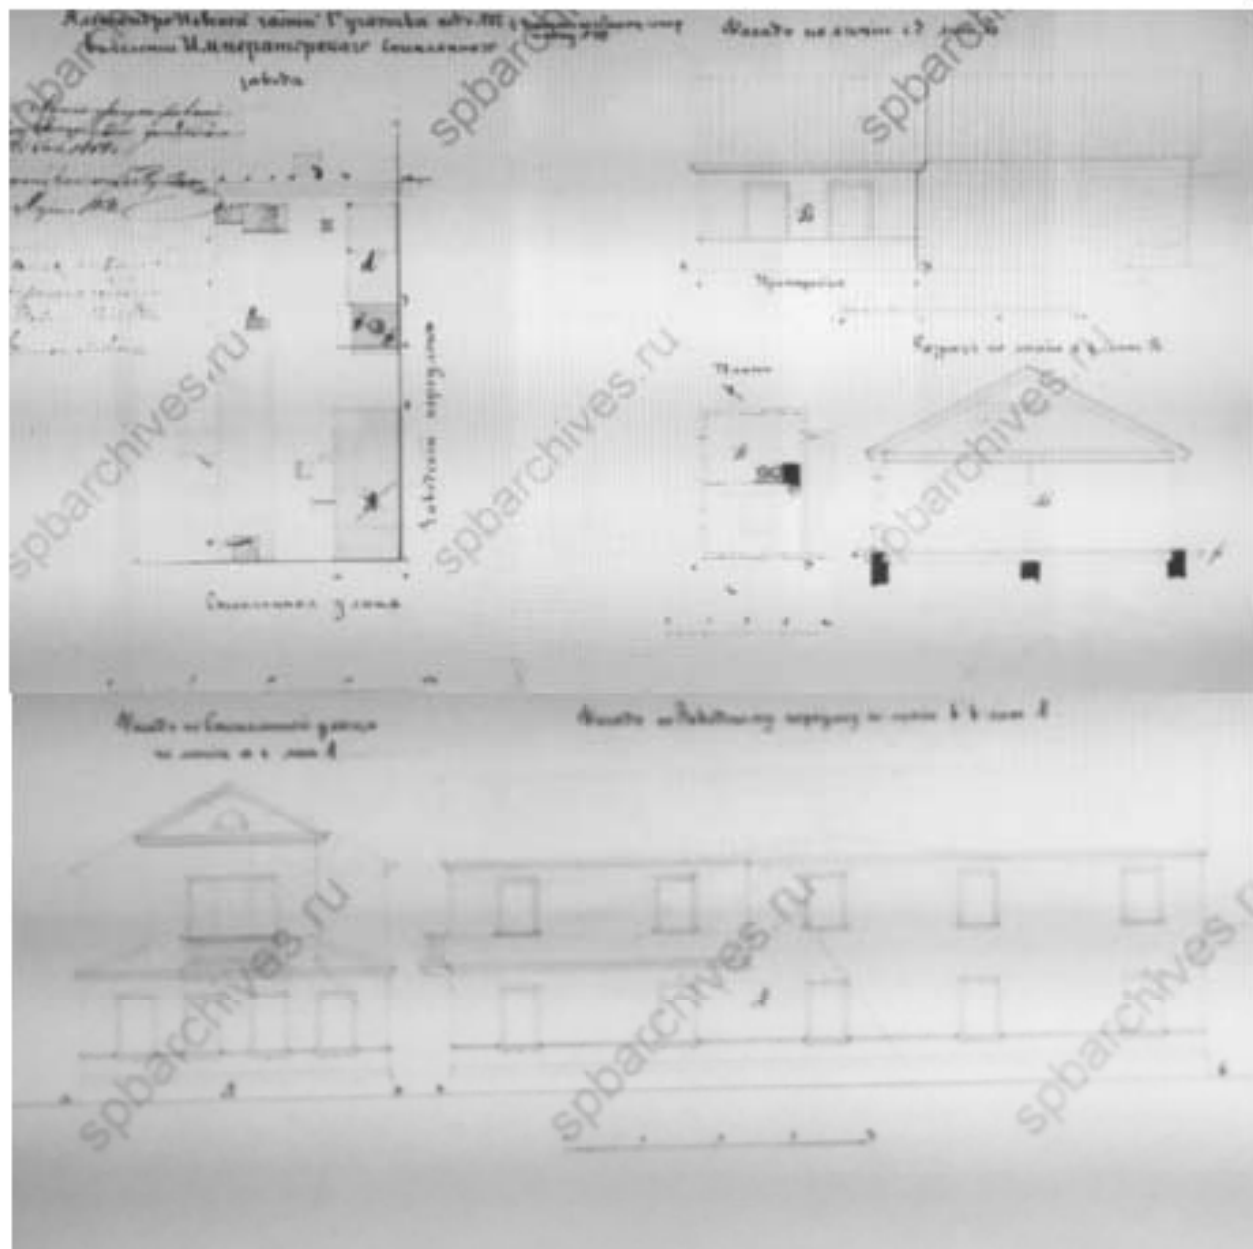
Участок по адресу Стекланная ул.,33/Фаянсовая ул.,4 план участка, фасад и разрезы зданий
